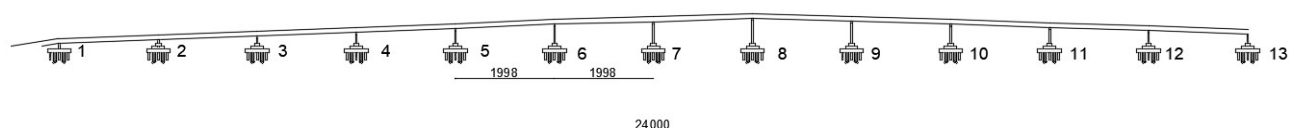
Disposição geral dos elementos estruturais (pilares)
